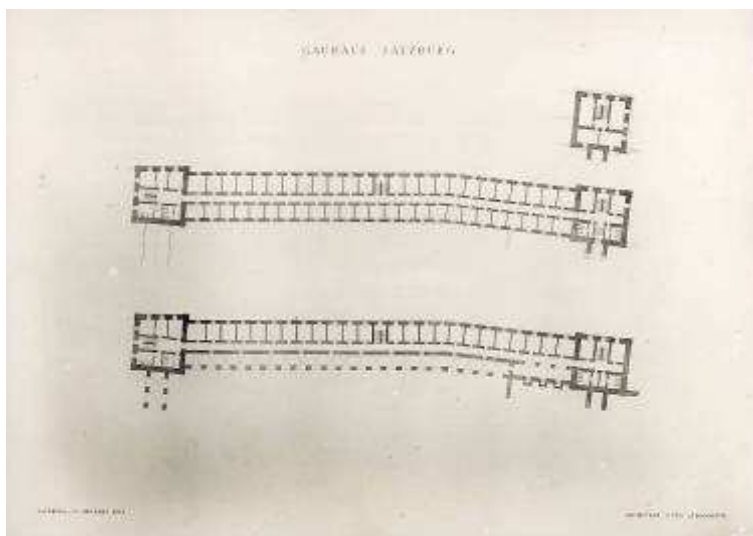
bis 37: Pläne Grundriss, Gauhaus, August 1942.
